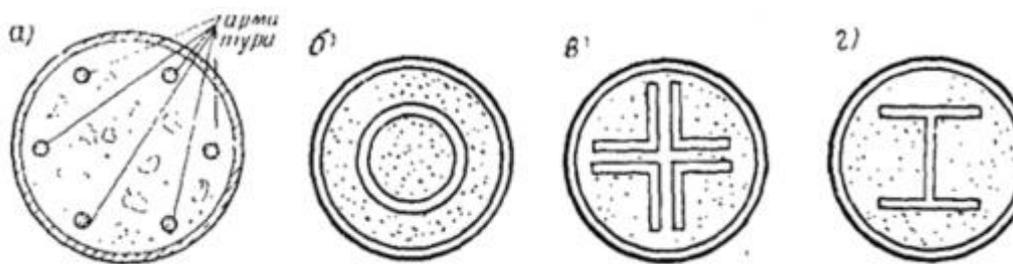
Армирование бетонного ядра: а – гибкой арматурой; б – жесткой арматурой в виде трубы; в – то же, уголком; г – то же, двутавром
